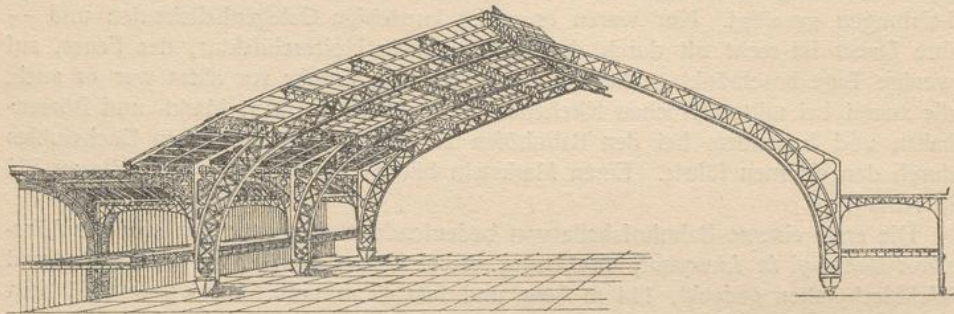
Hallenbau der Pariser Maschinenhalle auf der Ausstellung von 1889.
